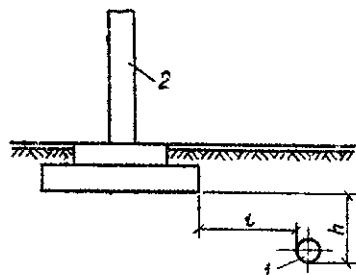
Прокладка подземной водосточной сети вдоль колонн
